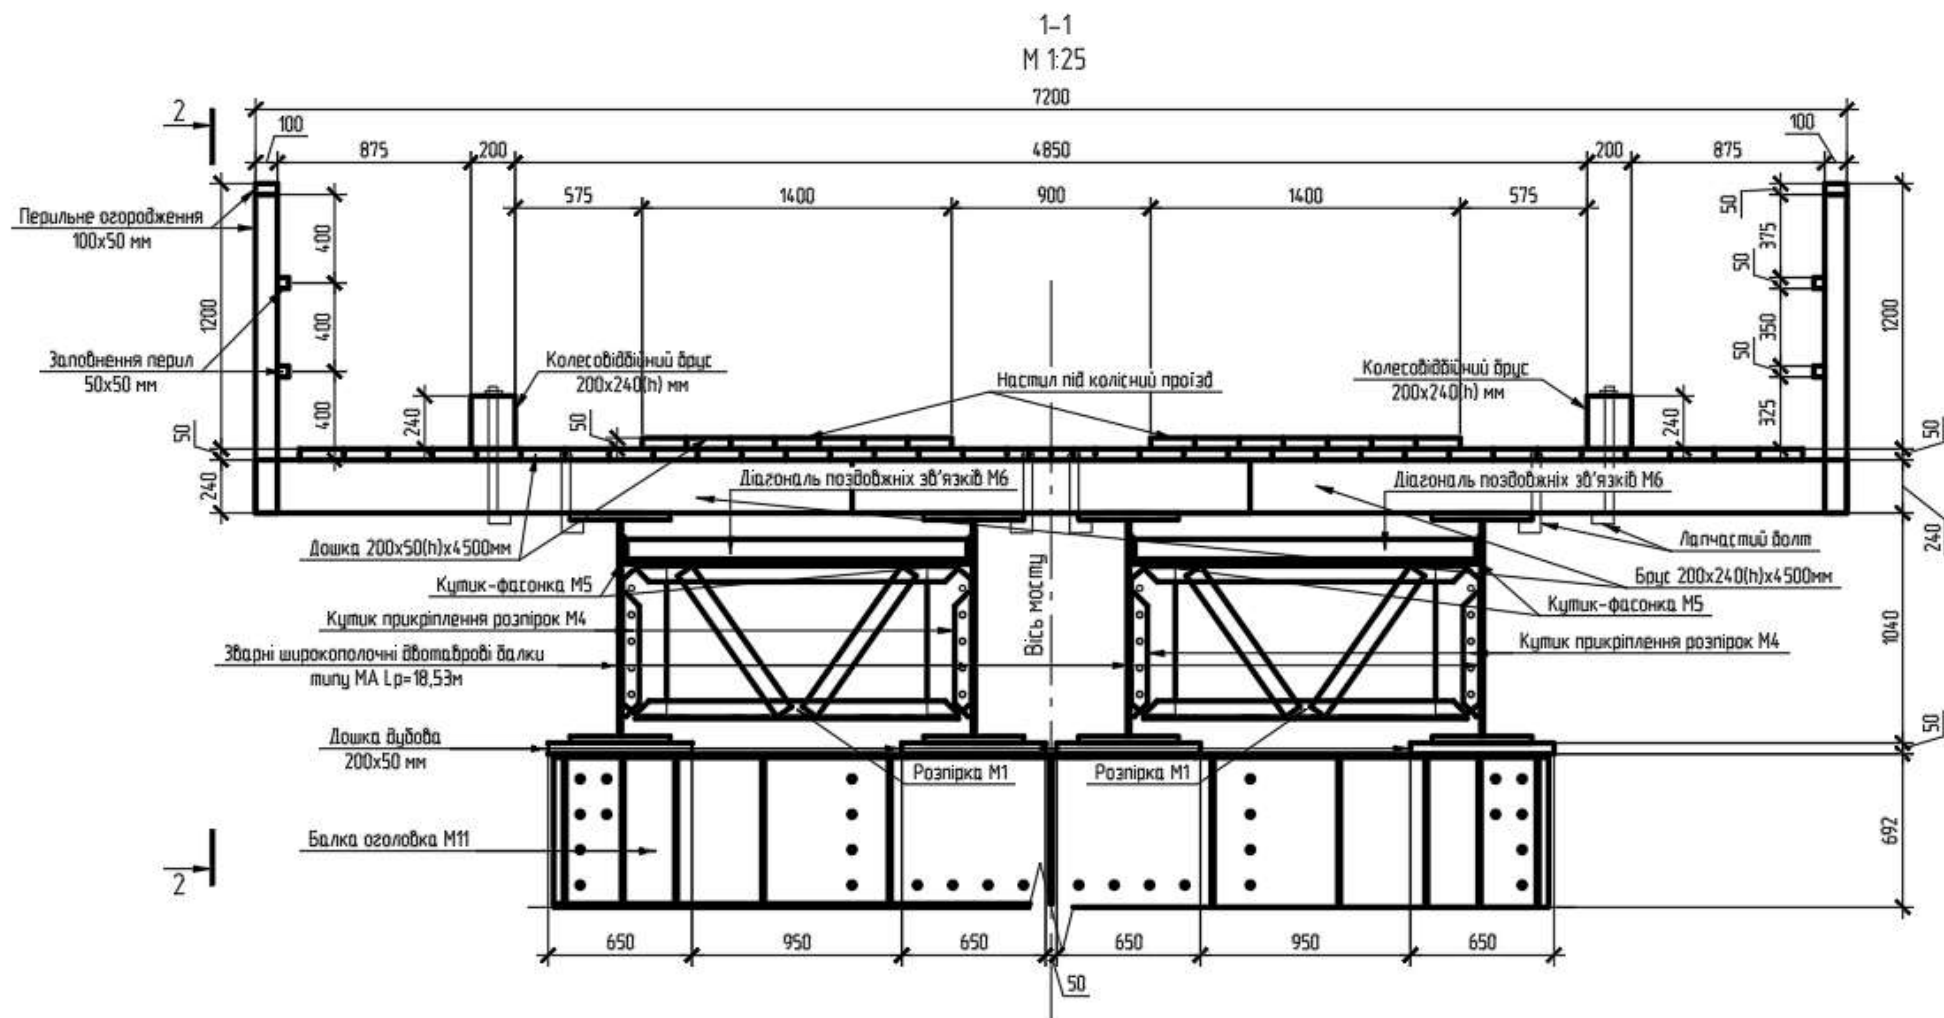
Влаштування балок прогонових будов. Переріз 1-1.
